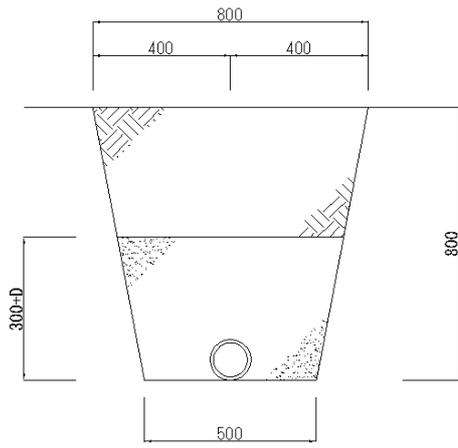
Plan structural standard d'ouvrage à pompe à pédale
